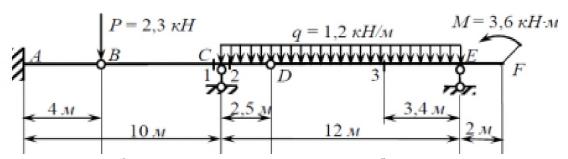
Заданная расчетная схема консольно-балочного прогона — многопролетной шарнирной балки
